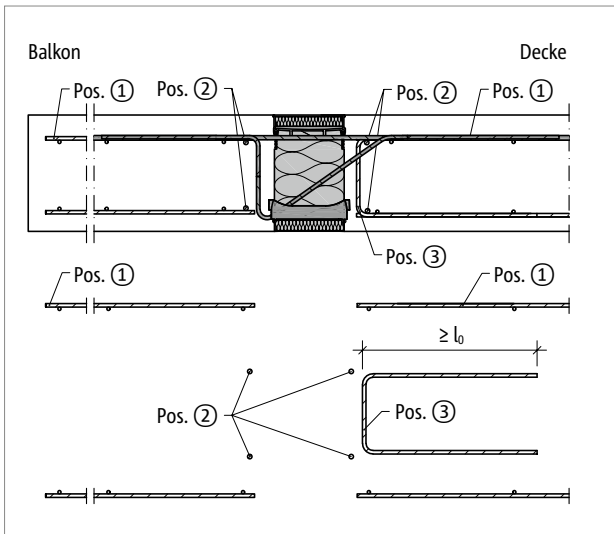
Schöck Isokorb® XT Typ KL: Bauseitige Bewehrung bei indirekter Lagerung
